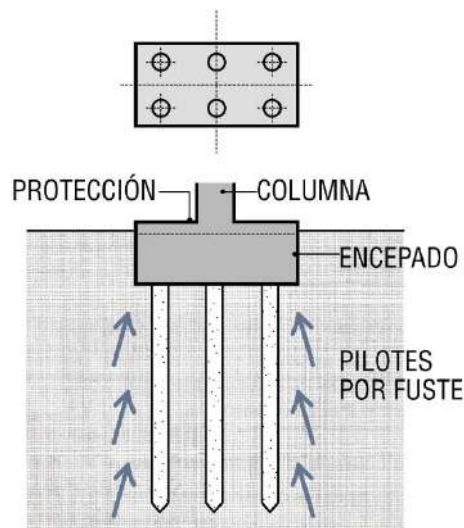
Esquema de cimentación de pilotes sobre el humedal
